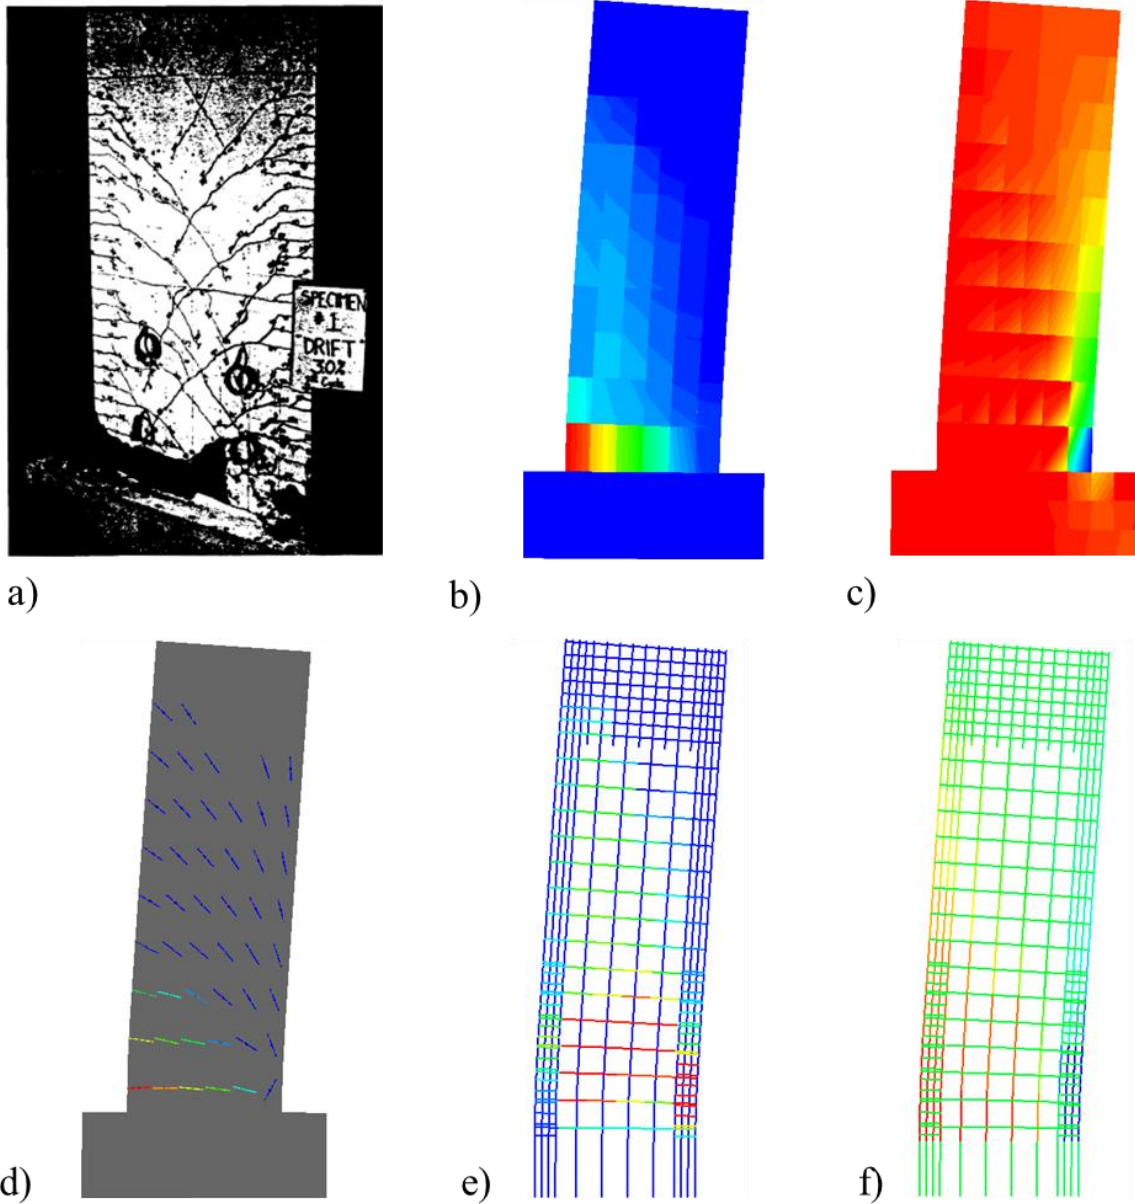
Comparación del estado de esfuerzos en el muro F cerca del punto de falla, a) Patrones de fisuración durante el ensayo al momento de la falla, b) deformaciones principales de tensión en el concreto, c) esfuerzos principales de compresión en el concreto, d) patrones de fisuración estimados, e) esfuerzos axiales en el refuerzo horizontal y f) esfuerzos axiales en el refuerzo vertical
